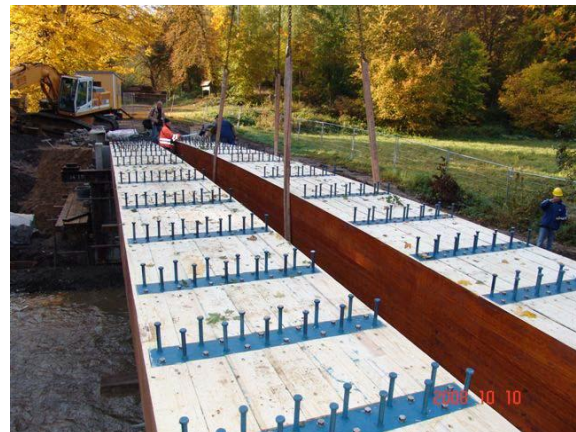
Montage des poutres en bois lamellé collé et leurs mises en place
